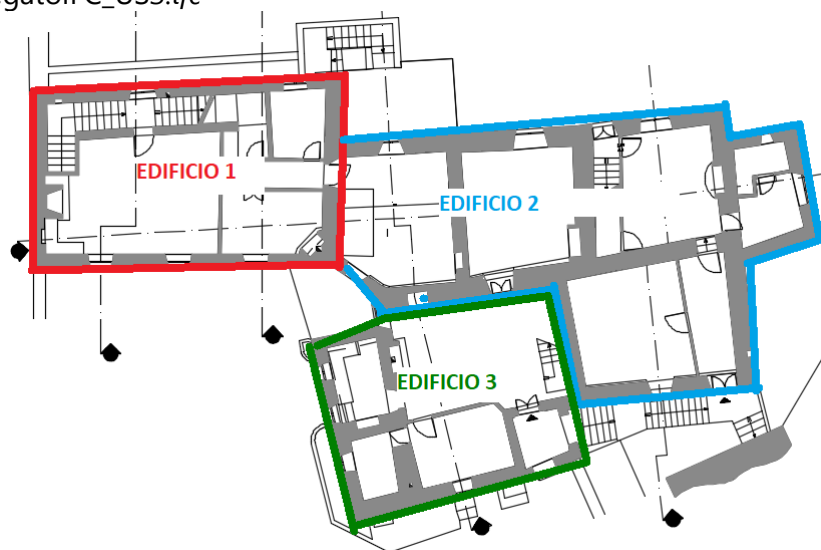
Suddivisione planimetrica di un aggregato in sottostrutture
